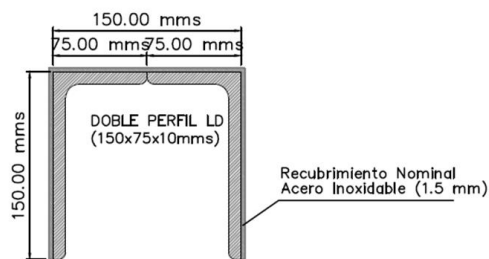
Sección prevista para el dintel en el Proyecto de Construcción.
